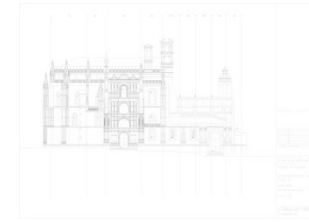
Exterior de la Catedral. Fachada Sur. Portada del Enlosado.
